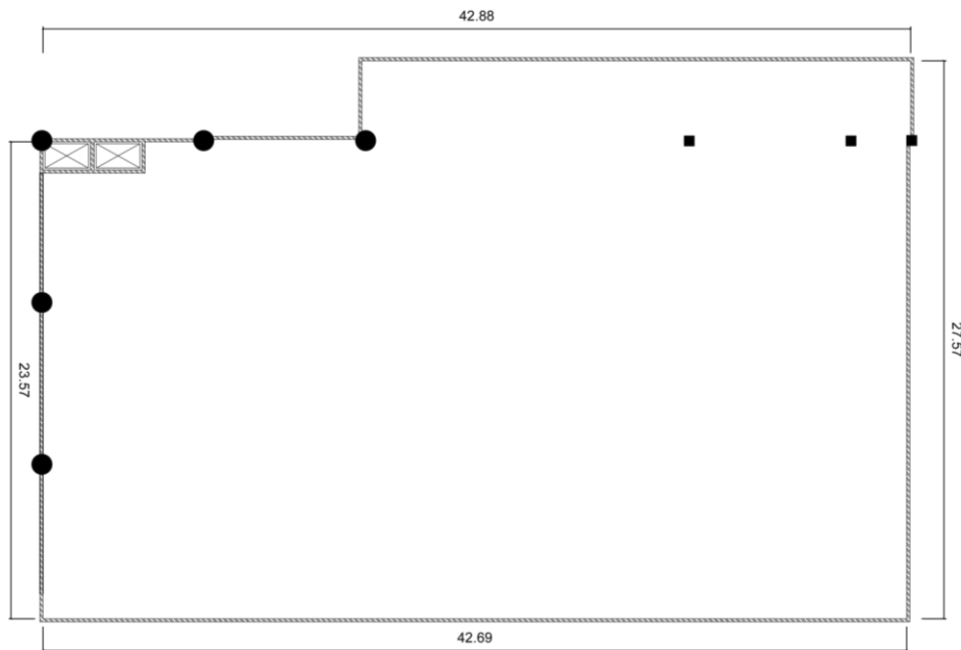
Tampak Potongan Bangunan Dyandra 2
